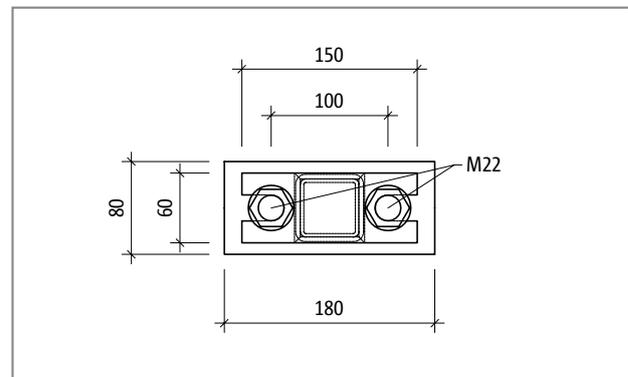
Schöck Isokorb® T type S-V-D22: Product elevation
